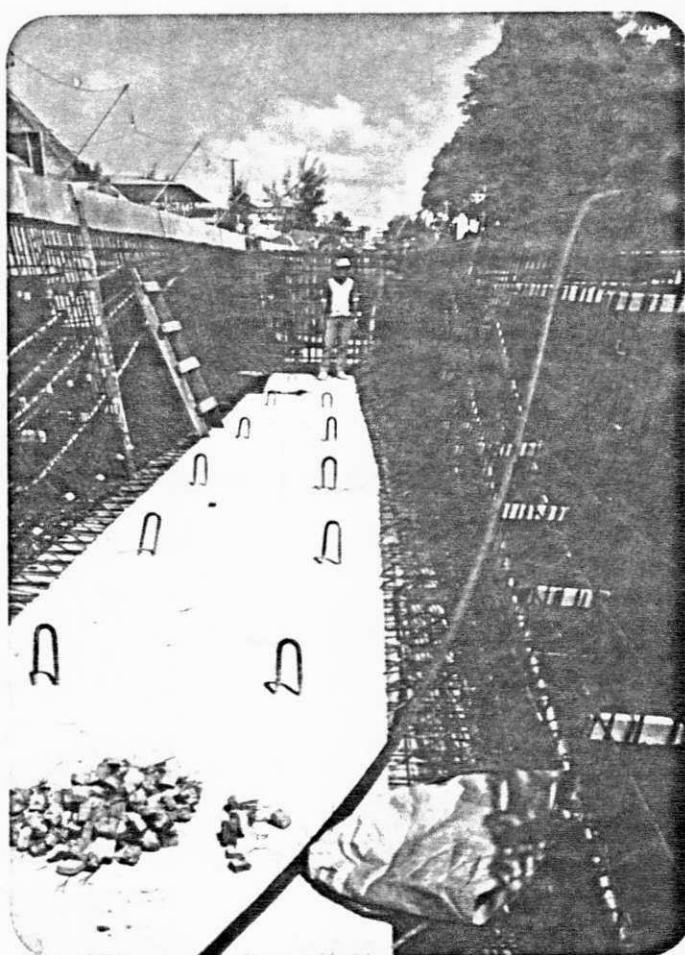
Vista da laje inferior do trecho I - Pista Esquerda já concretado, destacando-se as bainhas de protensão nas vigas laterais.
